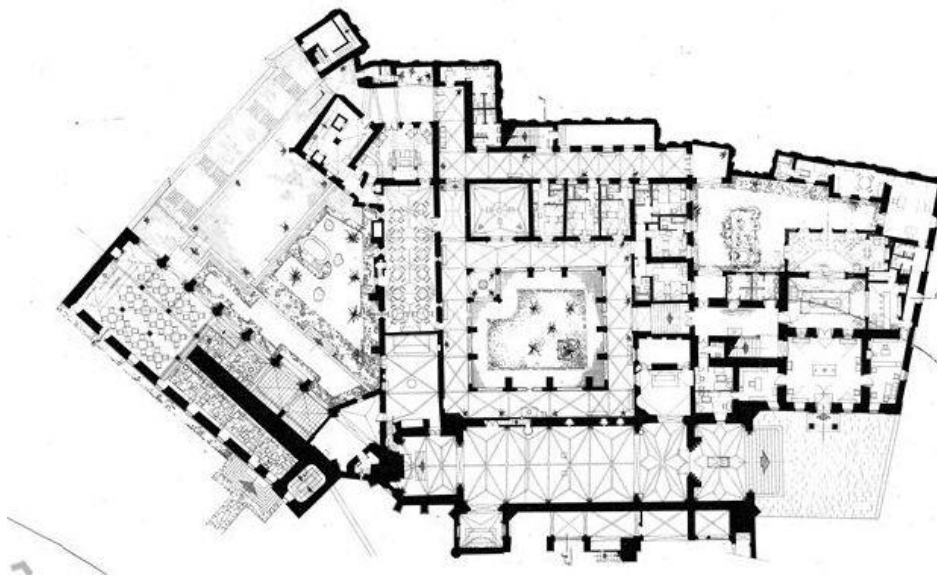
Planta dos pisos térreos do Convento de São João Evangelista.
